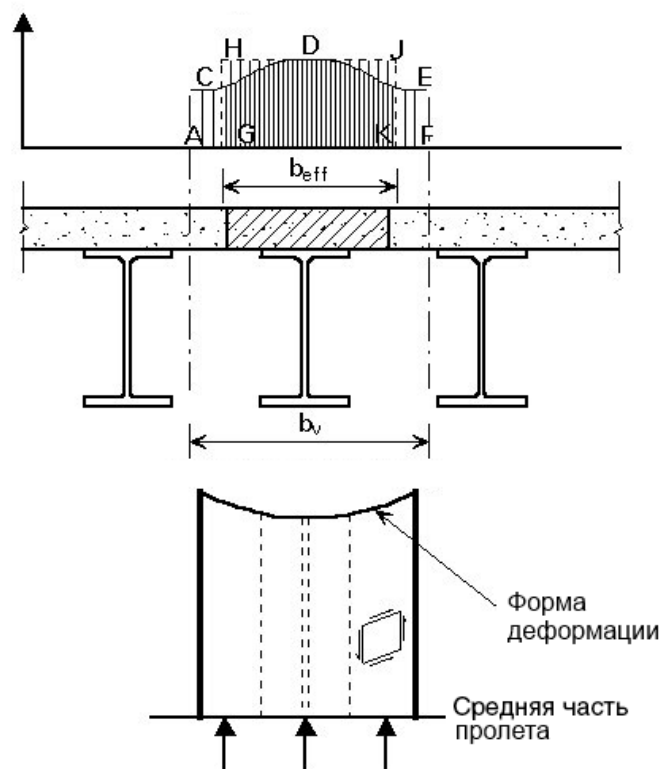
Эффект сдвигового запаздывания в бетонных полках сталежелезобетонных балок
